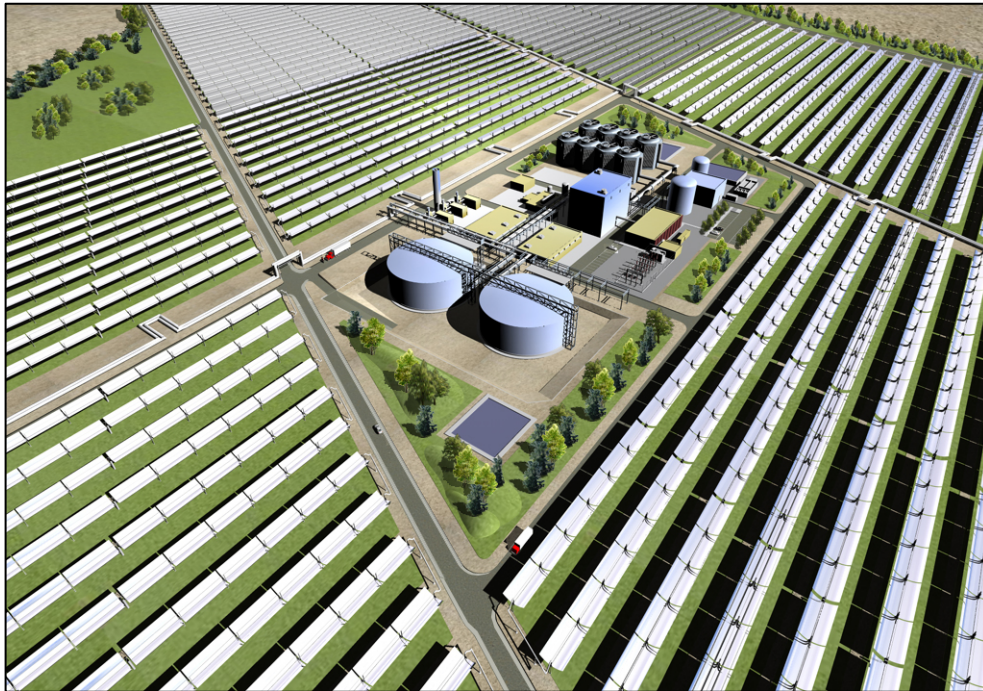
Modello Planovolumetrico - Dettaglio Power Block vista Sud-Est
